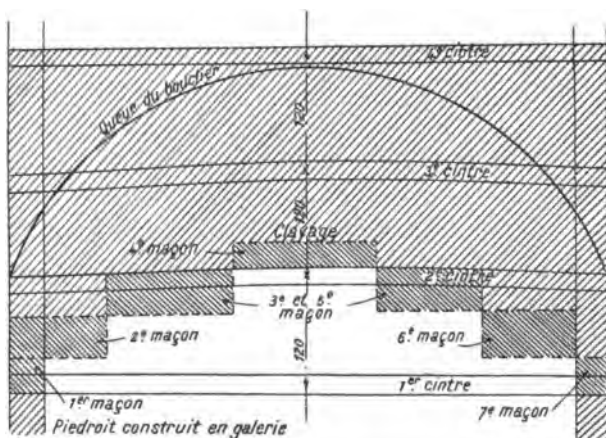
Chantier de maçonnerie, croquis schématique.
